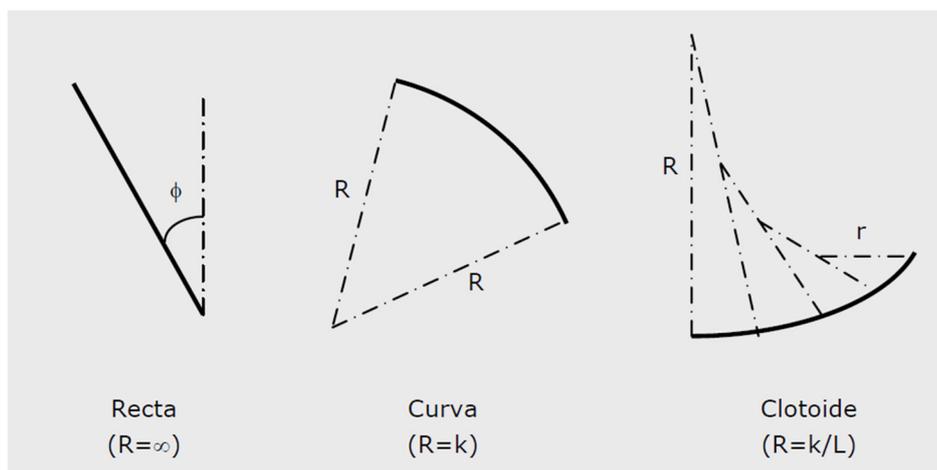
Alineaciones en planta empleadas en el trazado de carreteras
